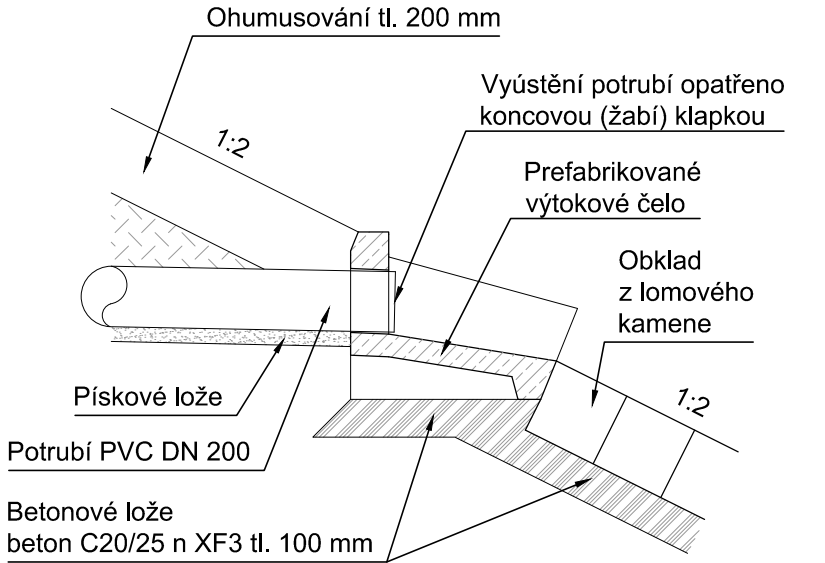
DETAIL ULOŽENÍ POTRUBÍ PVC DN200
